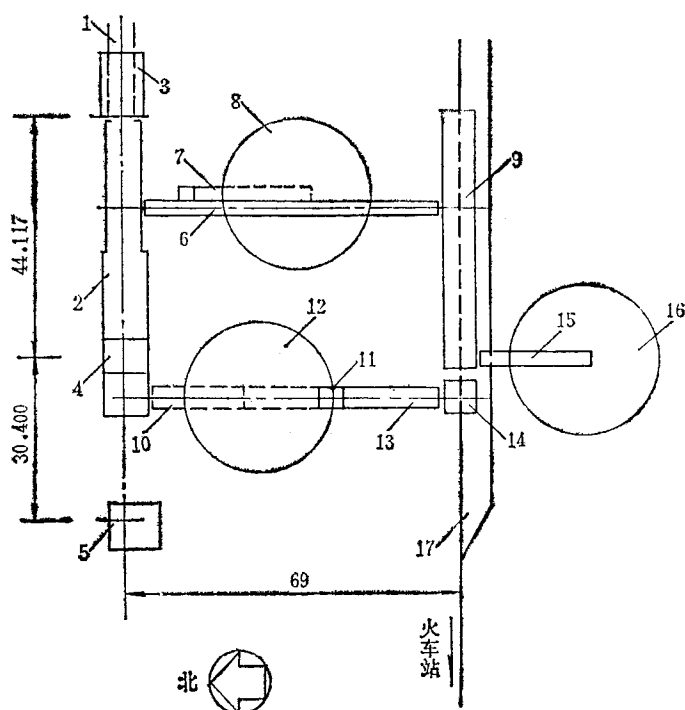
年产 30 万 t 矿井地面生产系统总平面布置图
